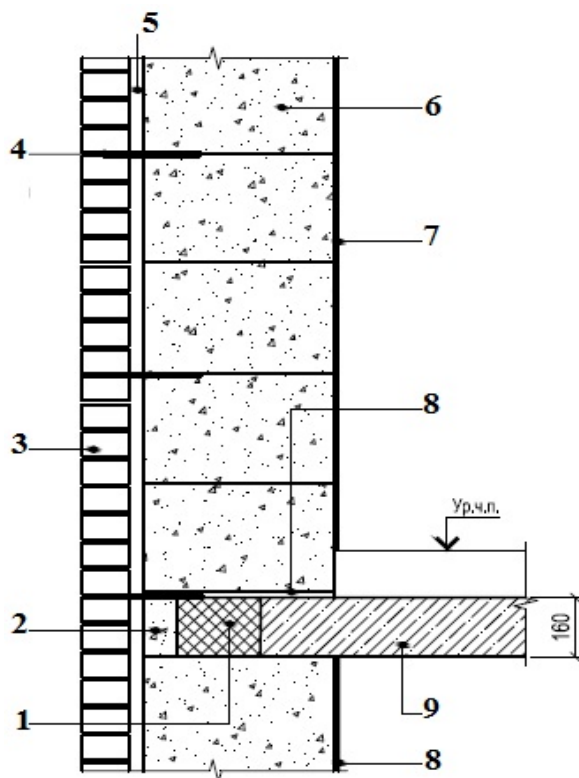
Крепление кирпичной кладки к несущей стене из газобетонных блоков и опирание перекрытий на стену (малоэтажное строительство): 1 — минераловатная плита; 2 — доборный блок, 125–150 мм; 3 — кладка из лицевого кирпича, 120 мм; 4 — связь Multi, шаг по вертикали и по горизонтали 600 мм; 5 — воздушный зазор, 40 мм; 6 — блоки YTONG; 7 — внутренняя отделка; 8 — шов из цементного раствора неармированный; 9 — монолитная железобетонная плита
